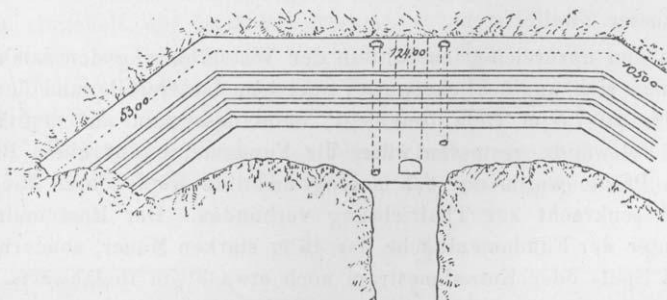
Alte Puentes - Mauer. Grundriss.
